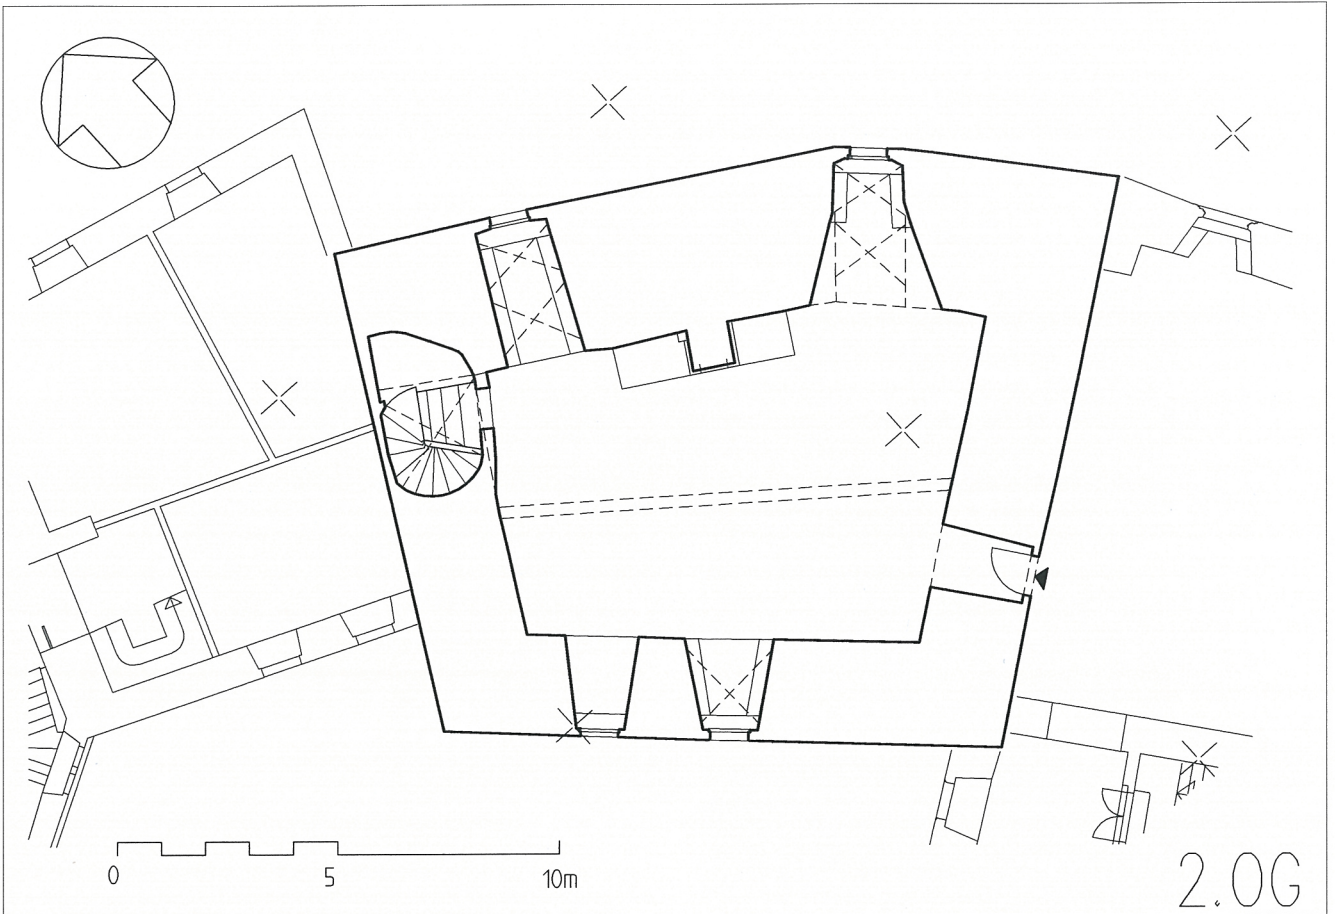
Grundriss 2. Obergeschoss „Saal“.
